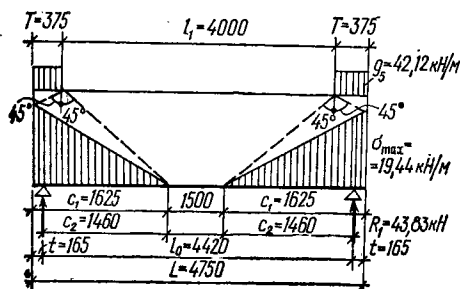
Расчетная схема фундаментной балки для второго случая загрузки
